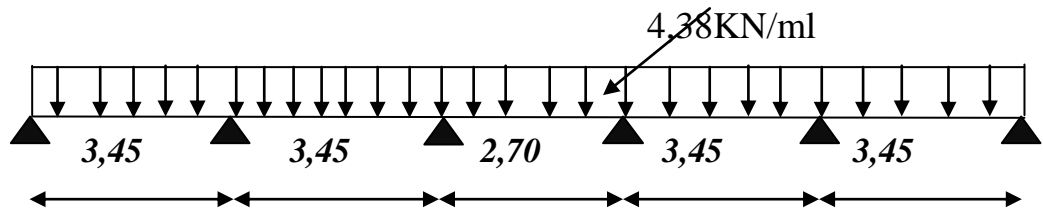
Schéma statique de la poutrelle à l'ELS
